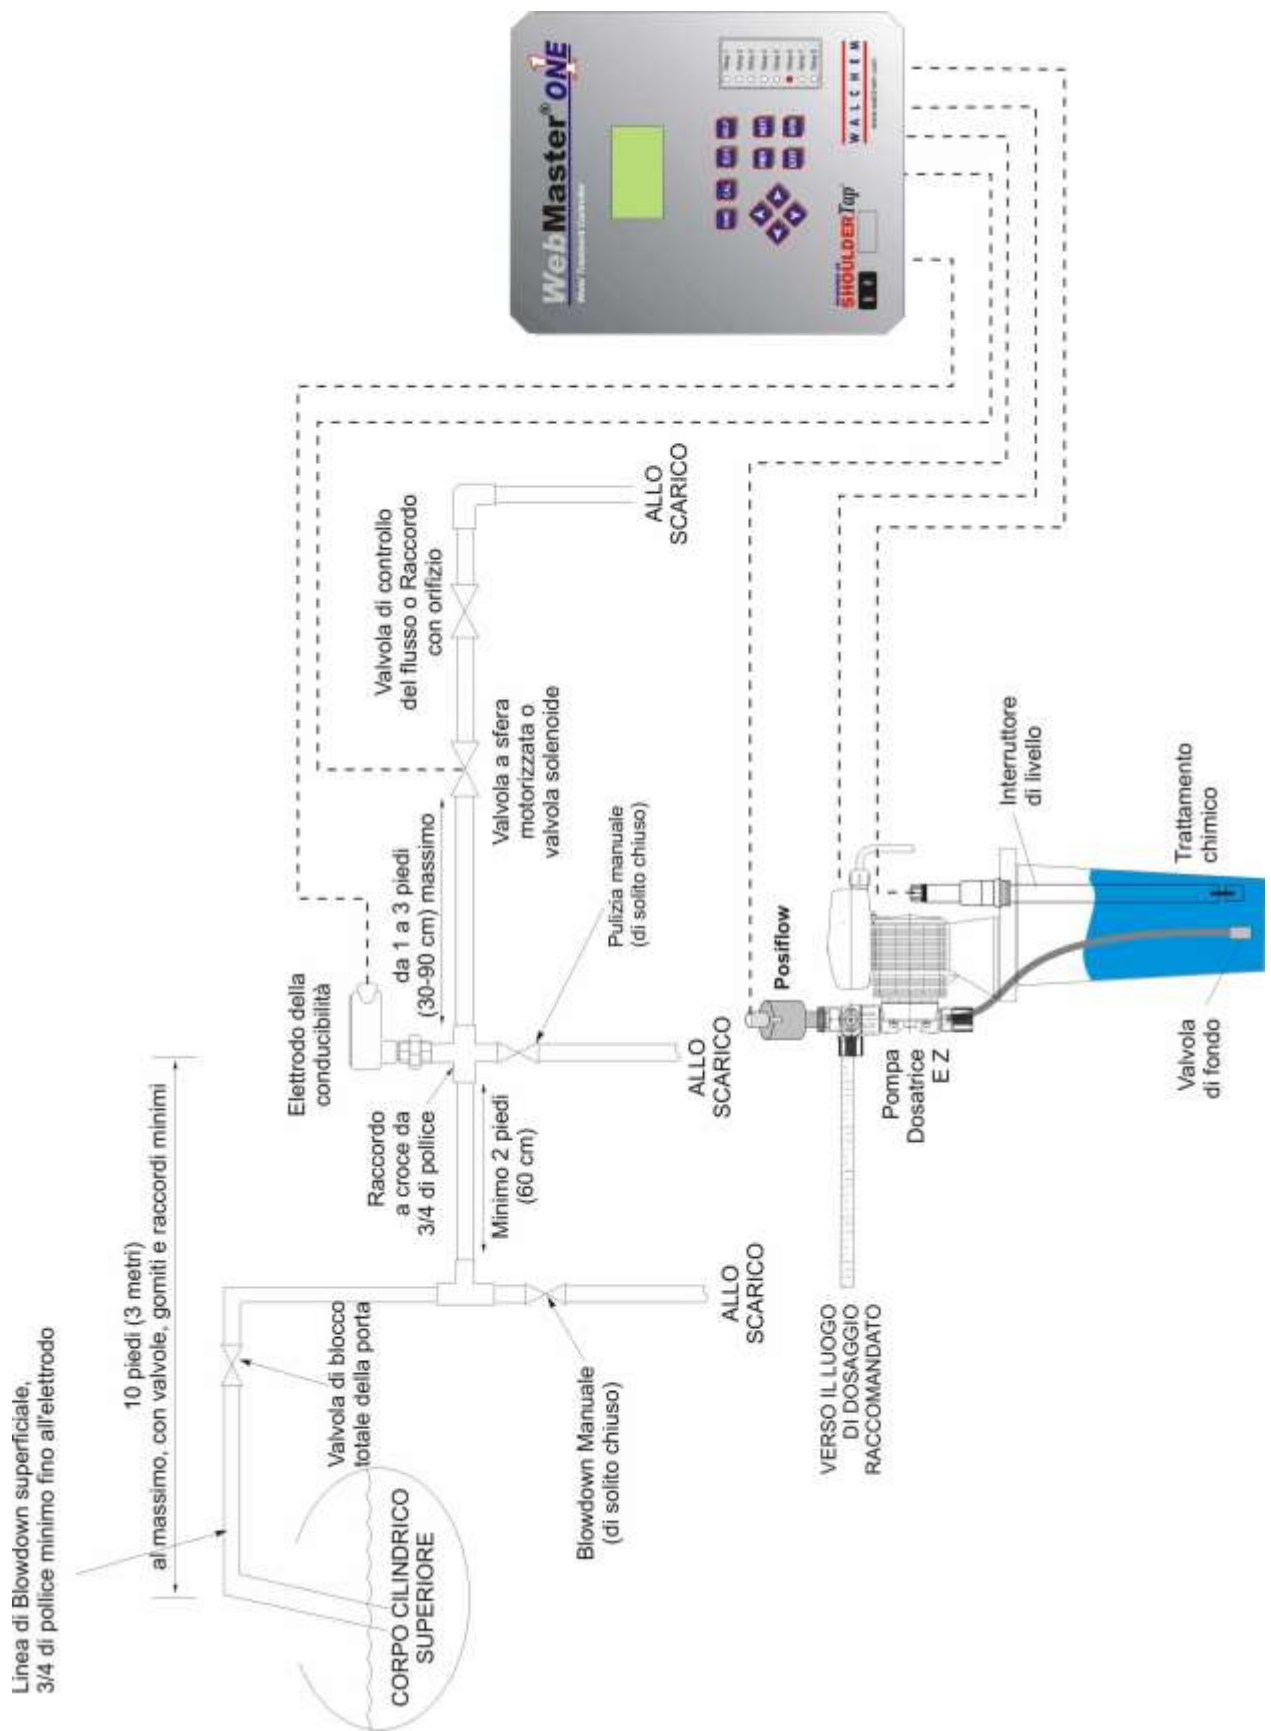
Installazione Tipica, Boiler Campionamento intermittente
